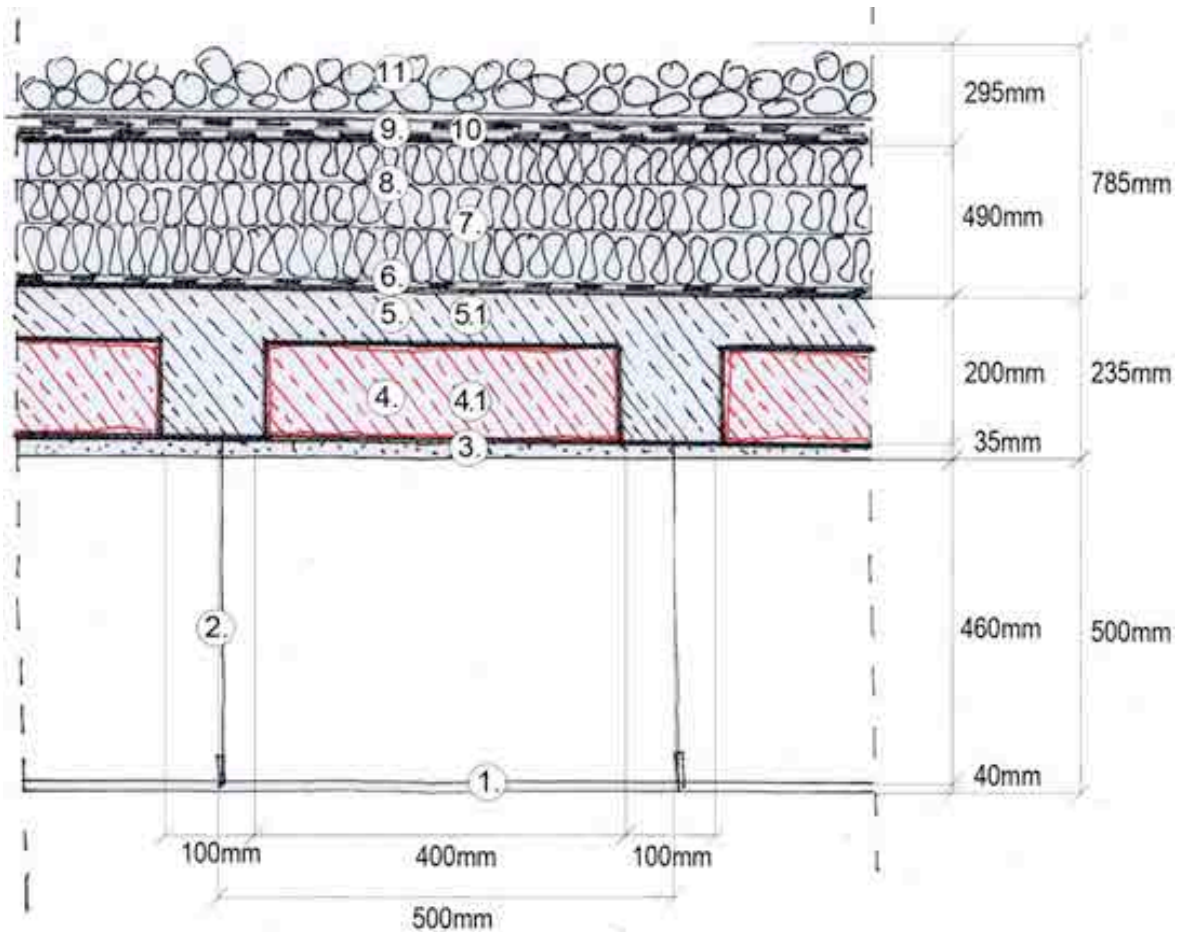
Bauteil, Dachbeläge, Decke Bestand und Neu\_20cm\_6cm
